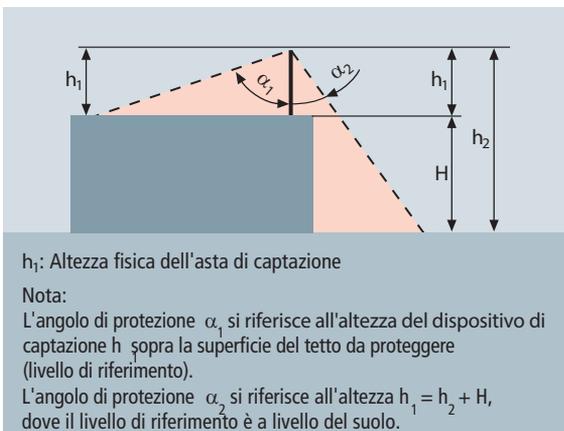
Volume protetto da un'asta di captazione verticale
